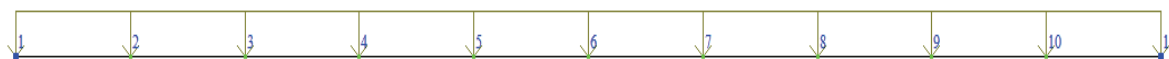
Розрахункова схема підсиленої сталезалізобетонної балки
